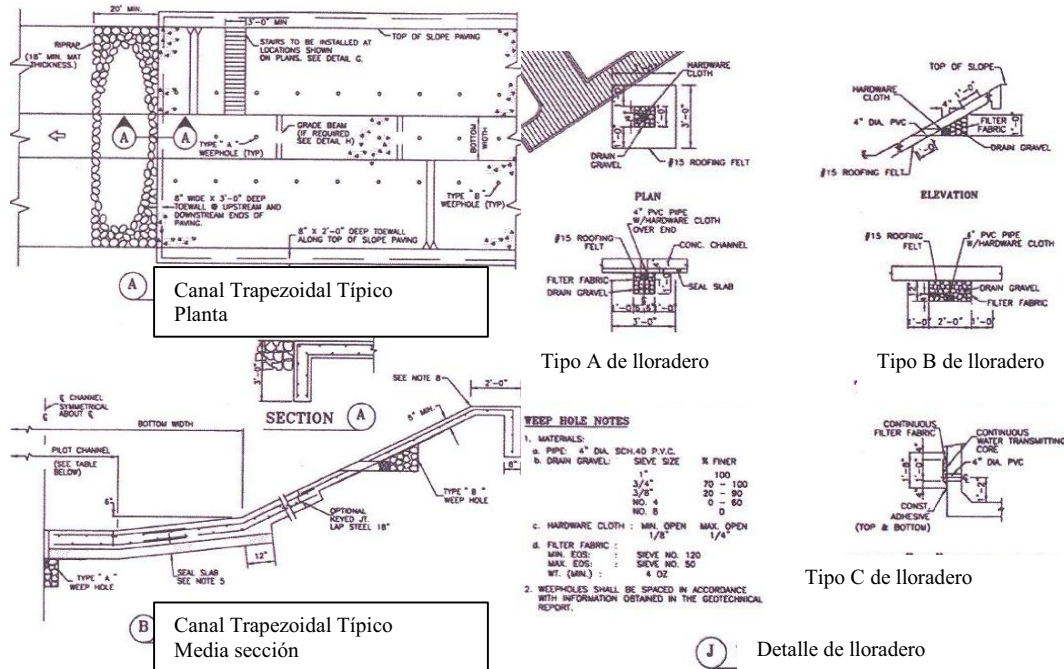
Detalles constructivos tipo de un canal recubierto de concreto
